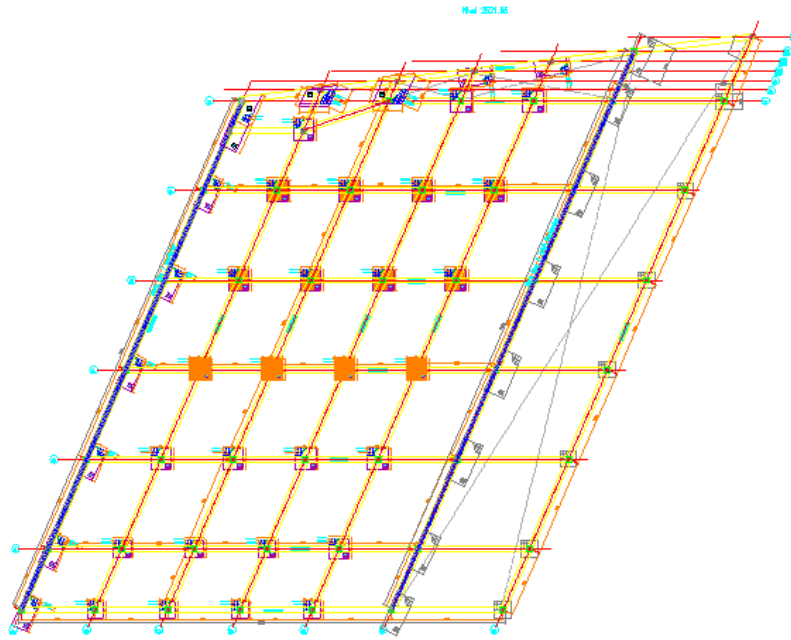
DISTRIBUCIÓN DE COLUMNAS ZONA COMÚN - SÓTANO. FUENTE: ADMINISTRACIÓN EDIFICIO
